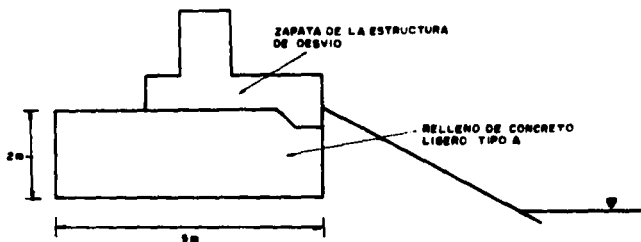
RCLC bajo la zapata de la estructura de desvío.
